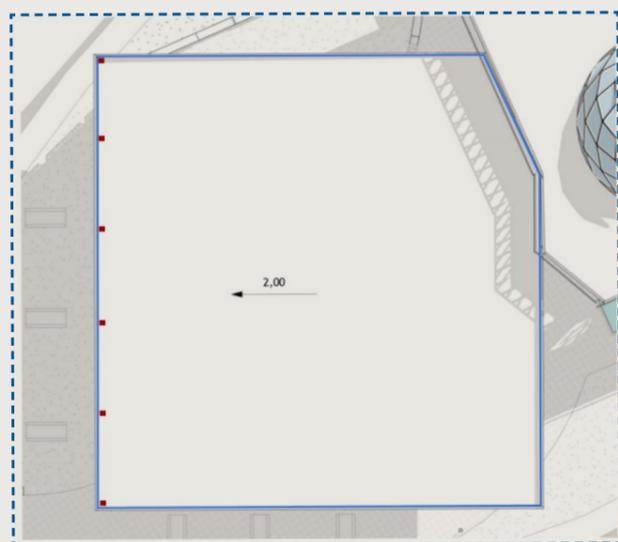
LAJE DO CENTRO DE PESQUISA - SUAS QUEDAS D'ÁGUA ACONTECEM NA FACHADA OESTE.
